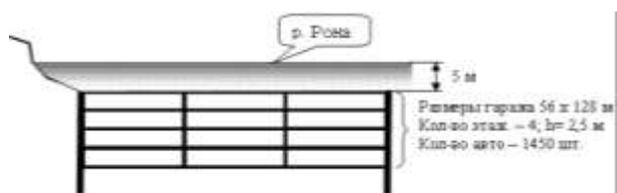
Схема устройства четырёхуровневого гаража под рекой по методу «стена в грунте»
